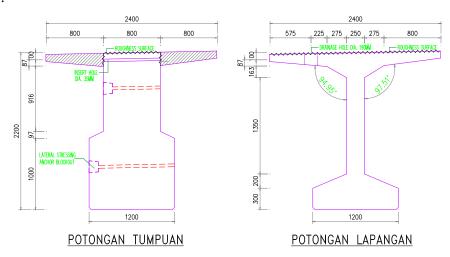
Dimensi Tampak samping Type Buld Tee Girder
